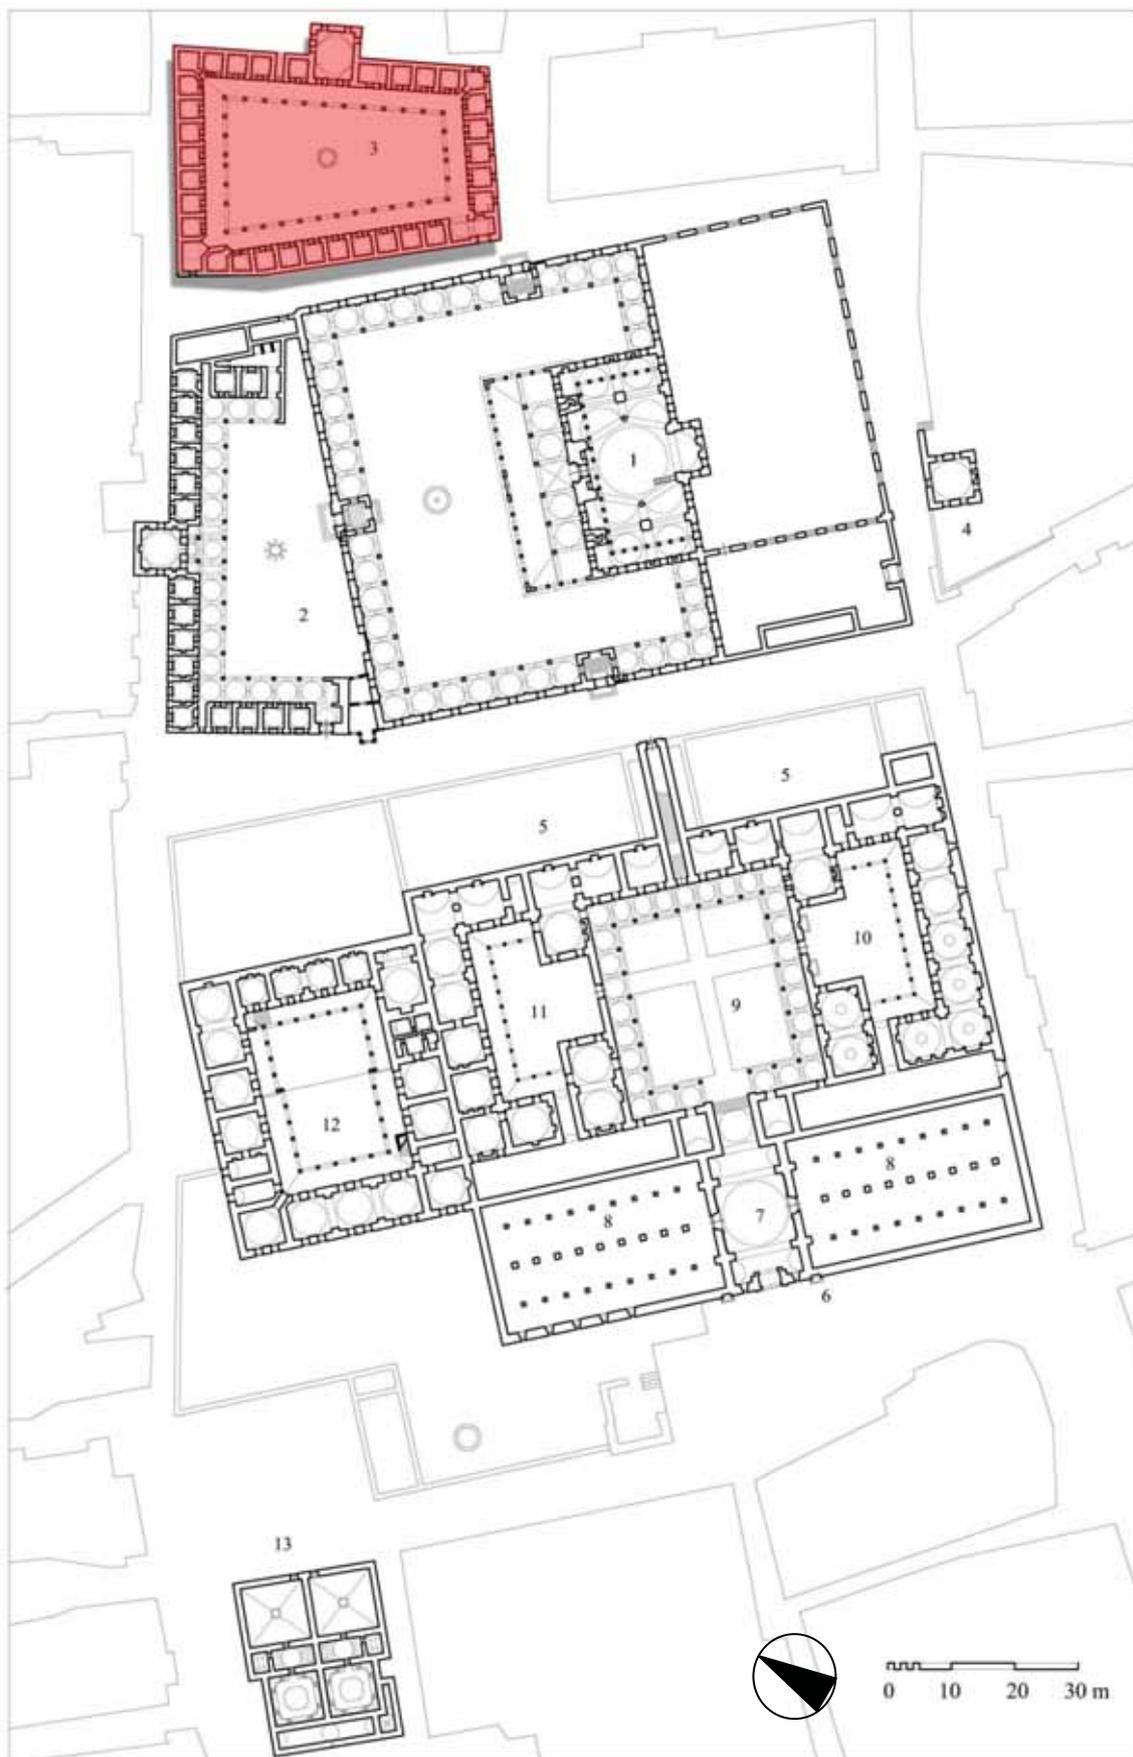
Grundriss und Lageplan vom Derwischhaus
